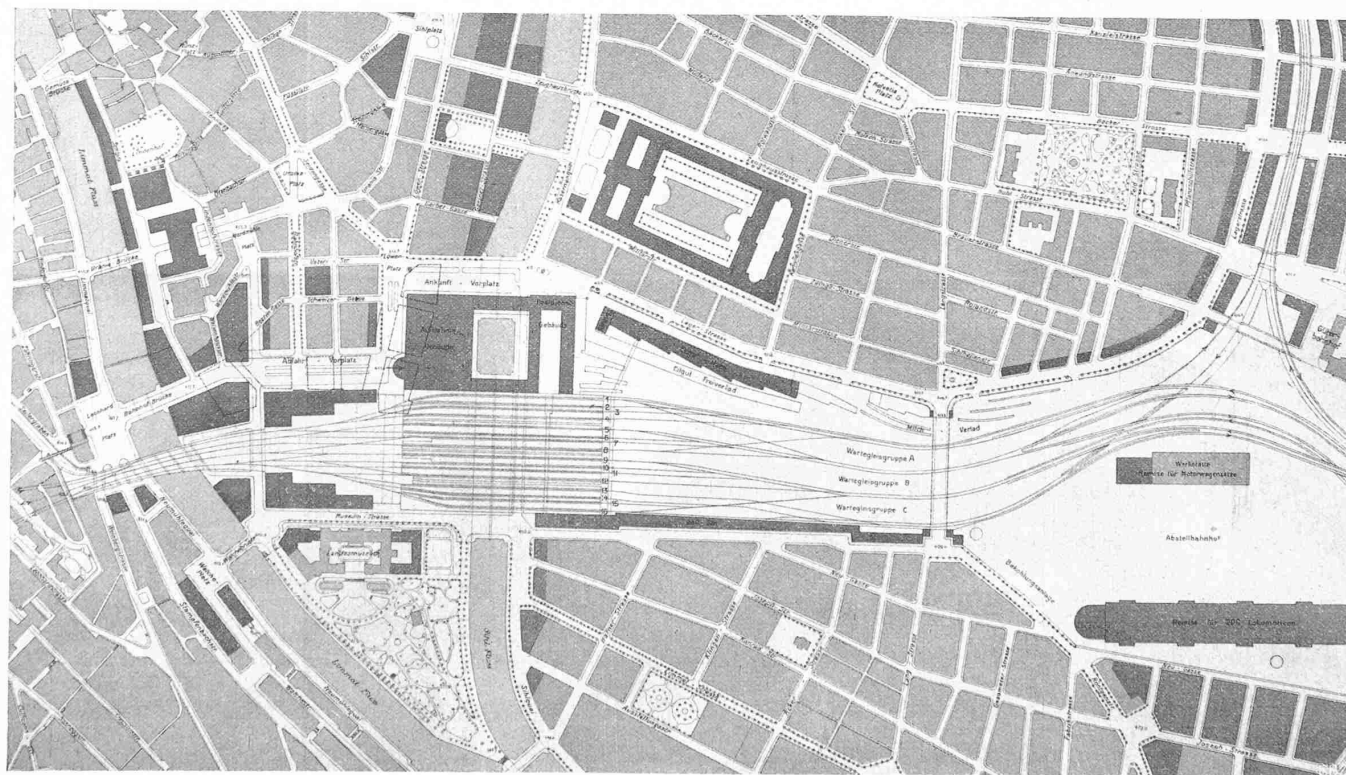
Bebauungsplan zum Durchgangsbahnhof 1918, Arch. Prof. K. Moser. — Ausschnitt im Masstab 1:10 000.
